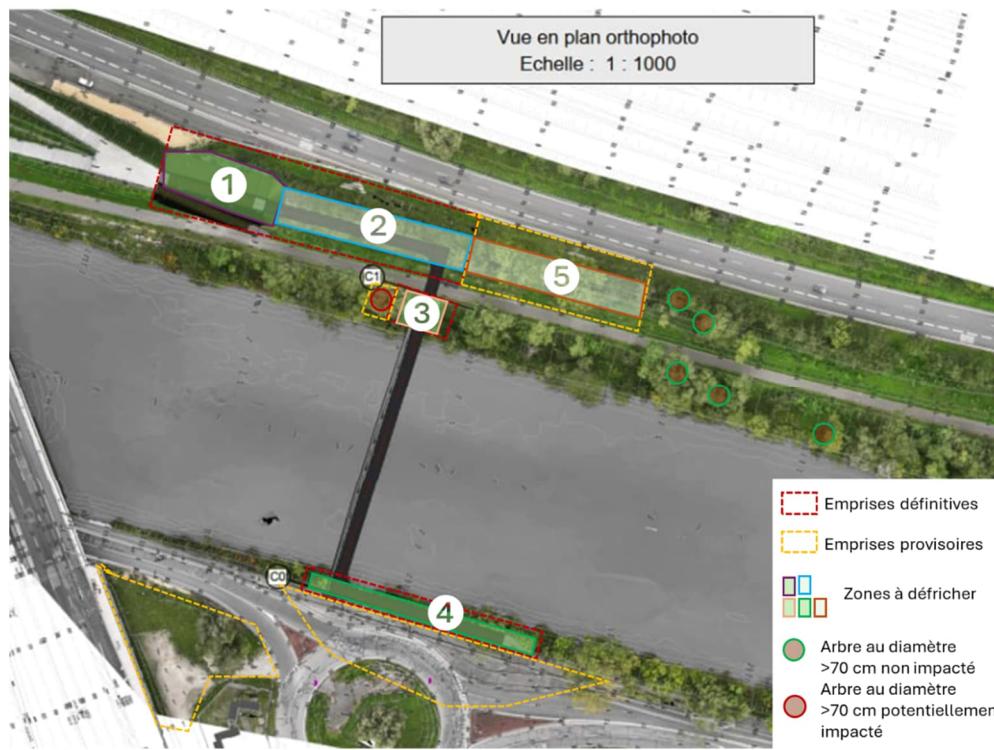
Emprises travaux supplémentaires en rive droite si installations de chantier charpente mises en place sur cette dernière
